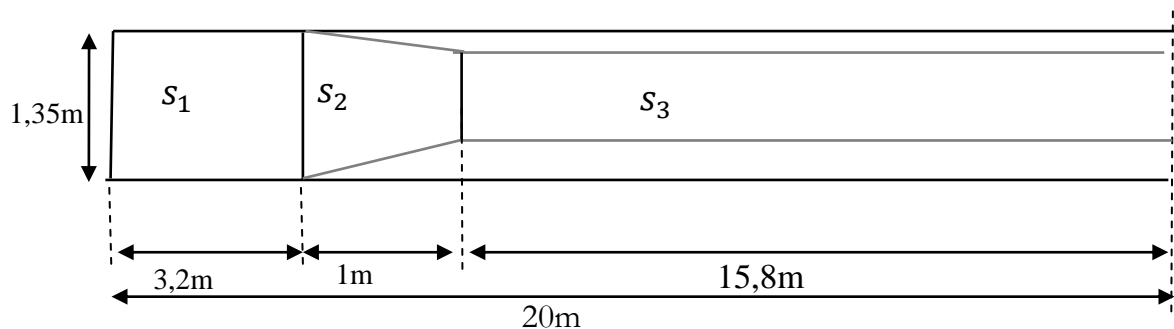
Vue latérale de la poutre en béton précontraint.
